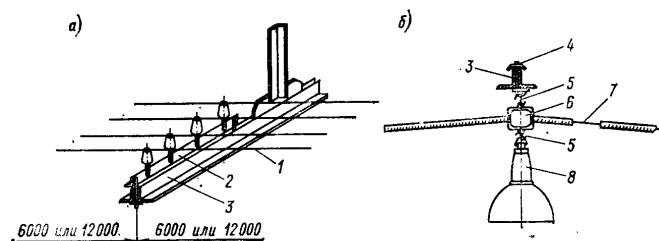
Проводка поперек ферм проводами на изоляторах (а) и тросовым
